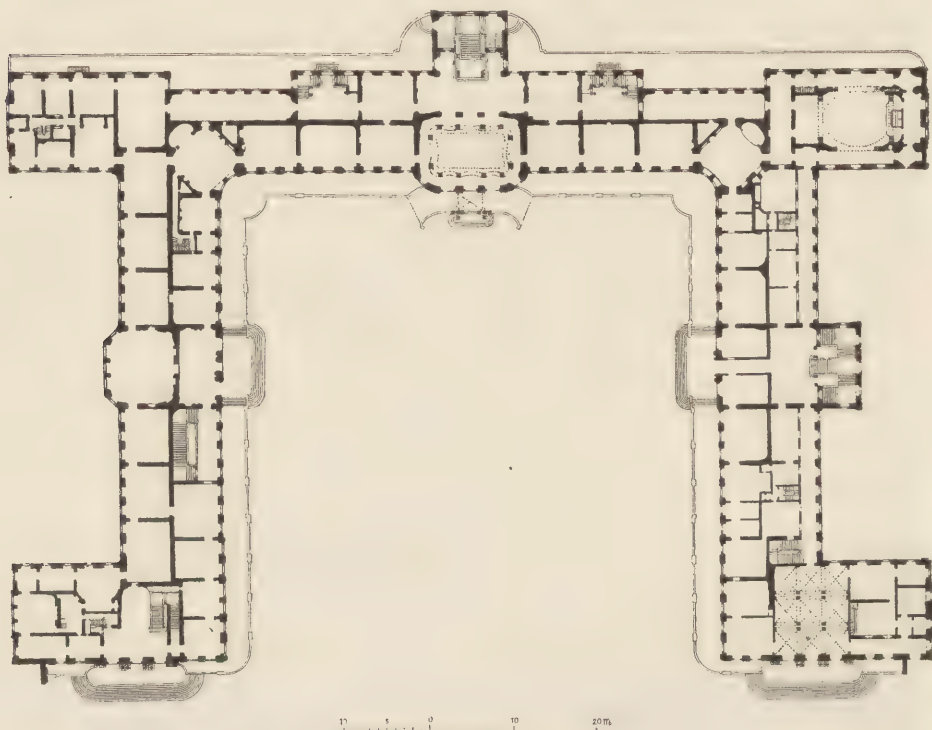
Residenzschloss zu Stuttgart. Grundriss.
